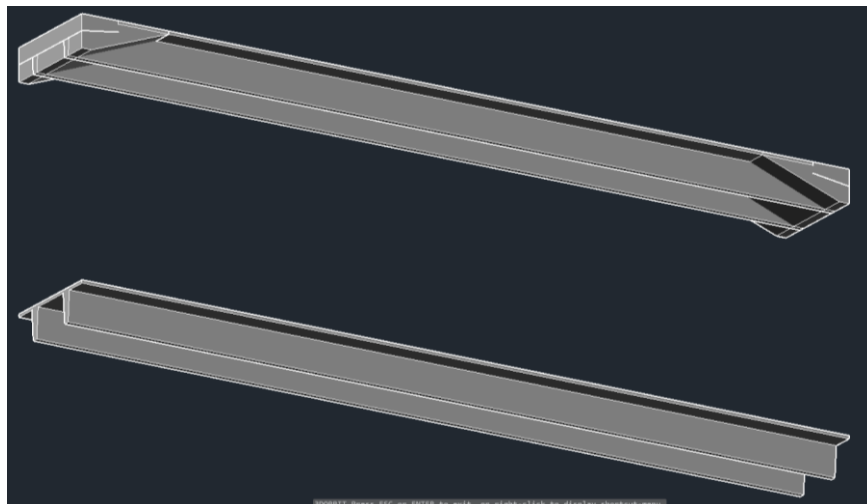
Estructura Modelada en AutoCAD Civil3D para modelamiento mediante "Solids"
